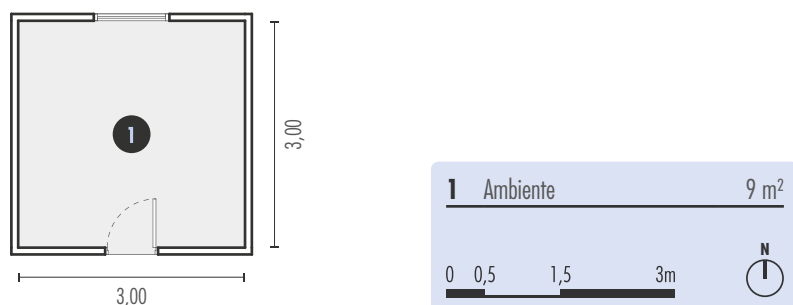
Planta baixa do modelo 01. Fonte: elaborado pela autora.
